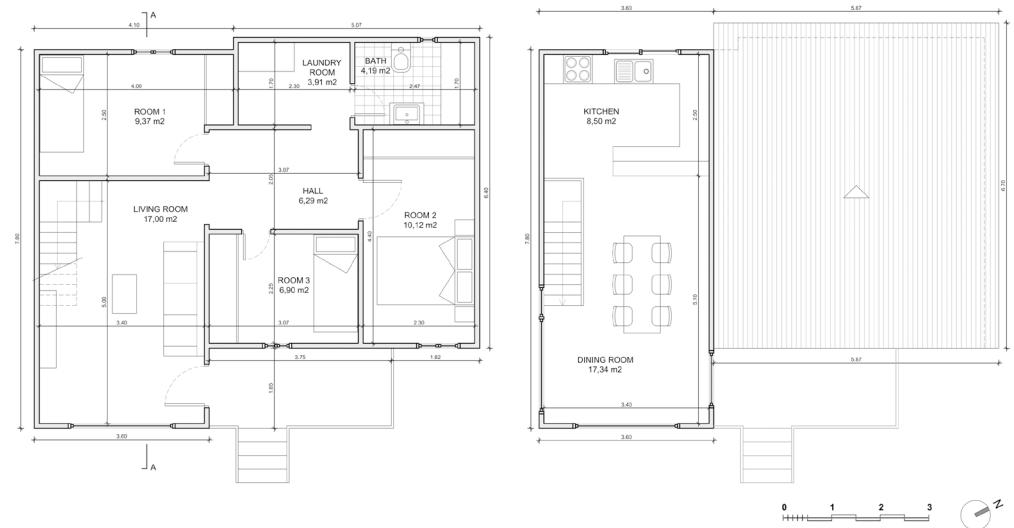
Vivienda II. Izquierda: Planta baja. Derecha: Primer piso
